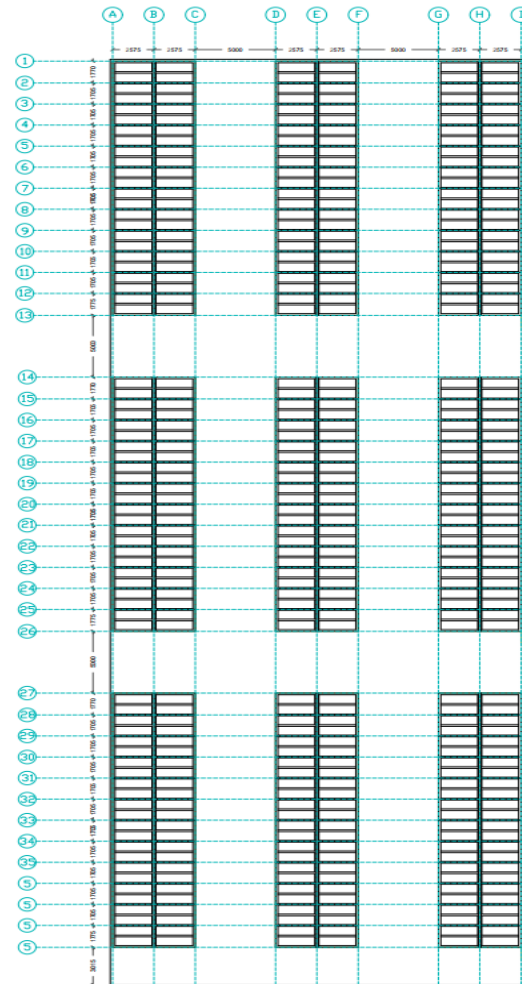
Plano del trazado de la losa de cimentación y ubicación de cada bóveda.
